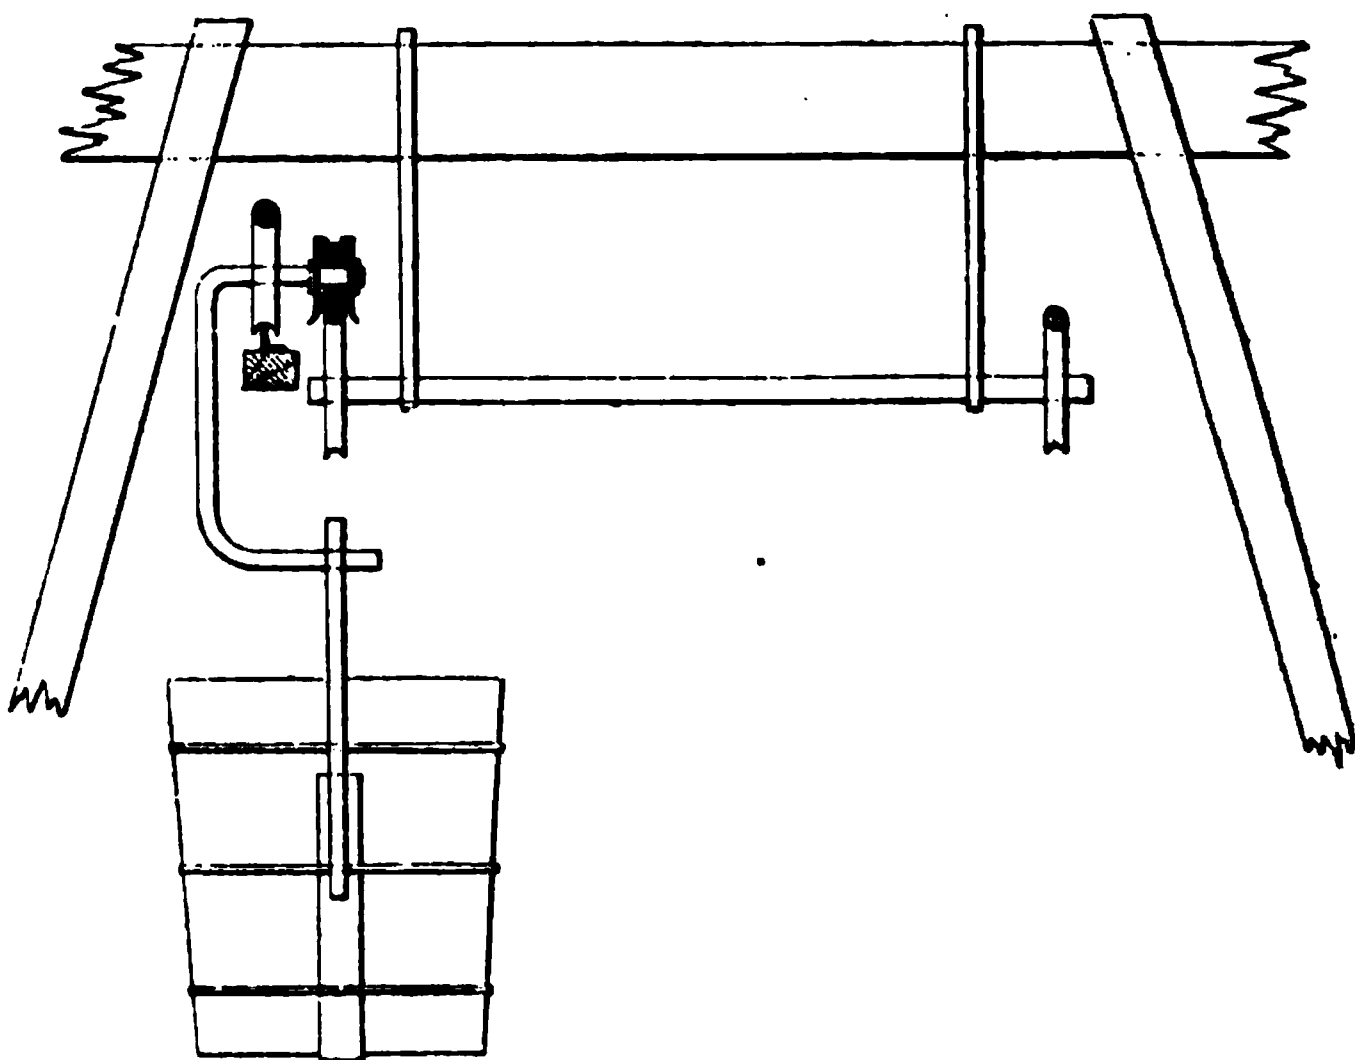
Plan aérien, système Hodgson (coupe transversale).
